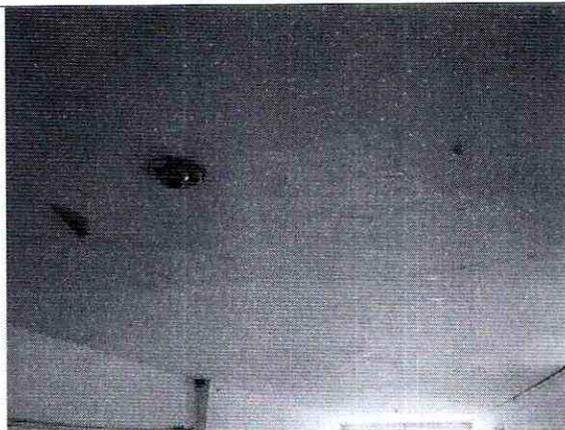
Fisuras en el cielo raso bajo el entrepiso
